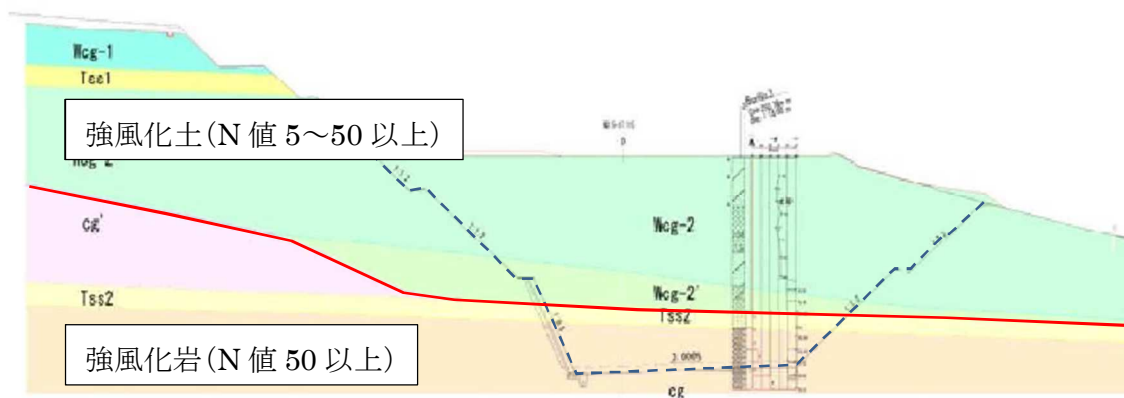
地層断面図 (No. 384+60 : 当初)
